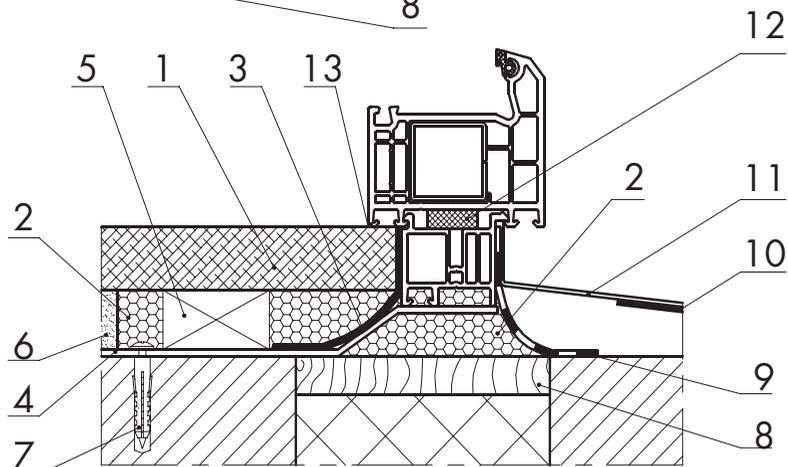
Узел нижнего примыкания оконного блока, подоконника и слива к проему слоистой стены с эффективным утеплителем
